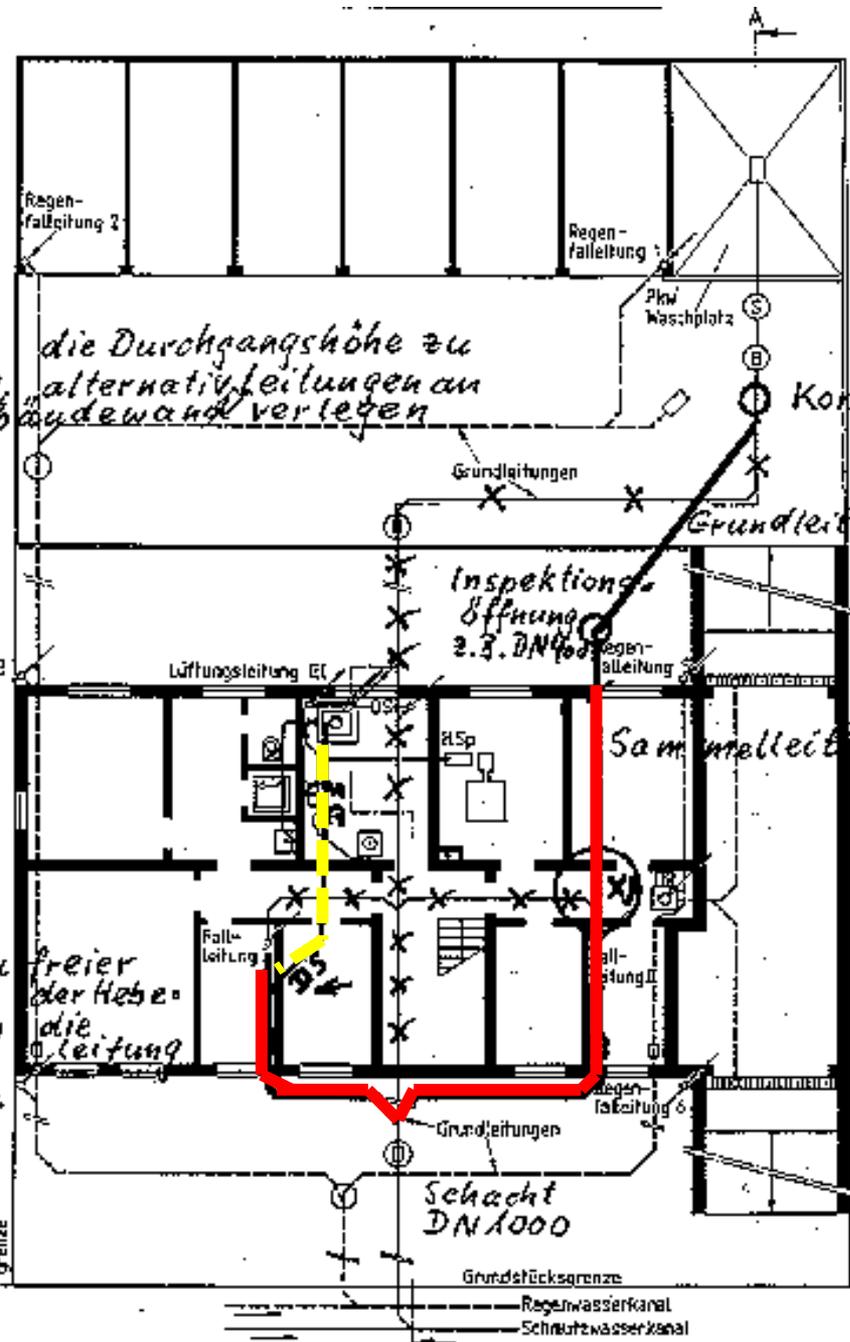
Kellergeschoss mit Grund- und Sammelleitungen sowie Abwasserhebeanlage beim Trennverfahren
